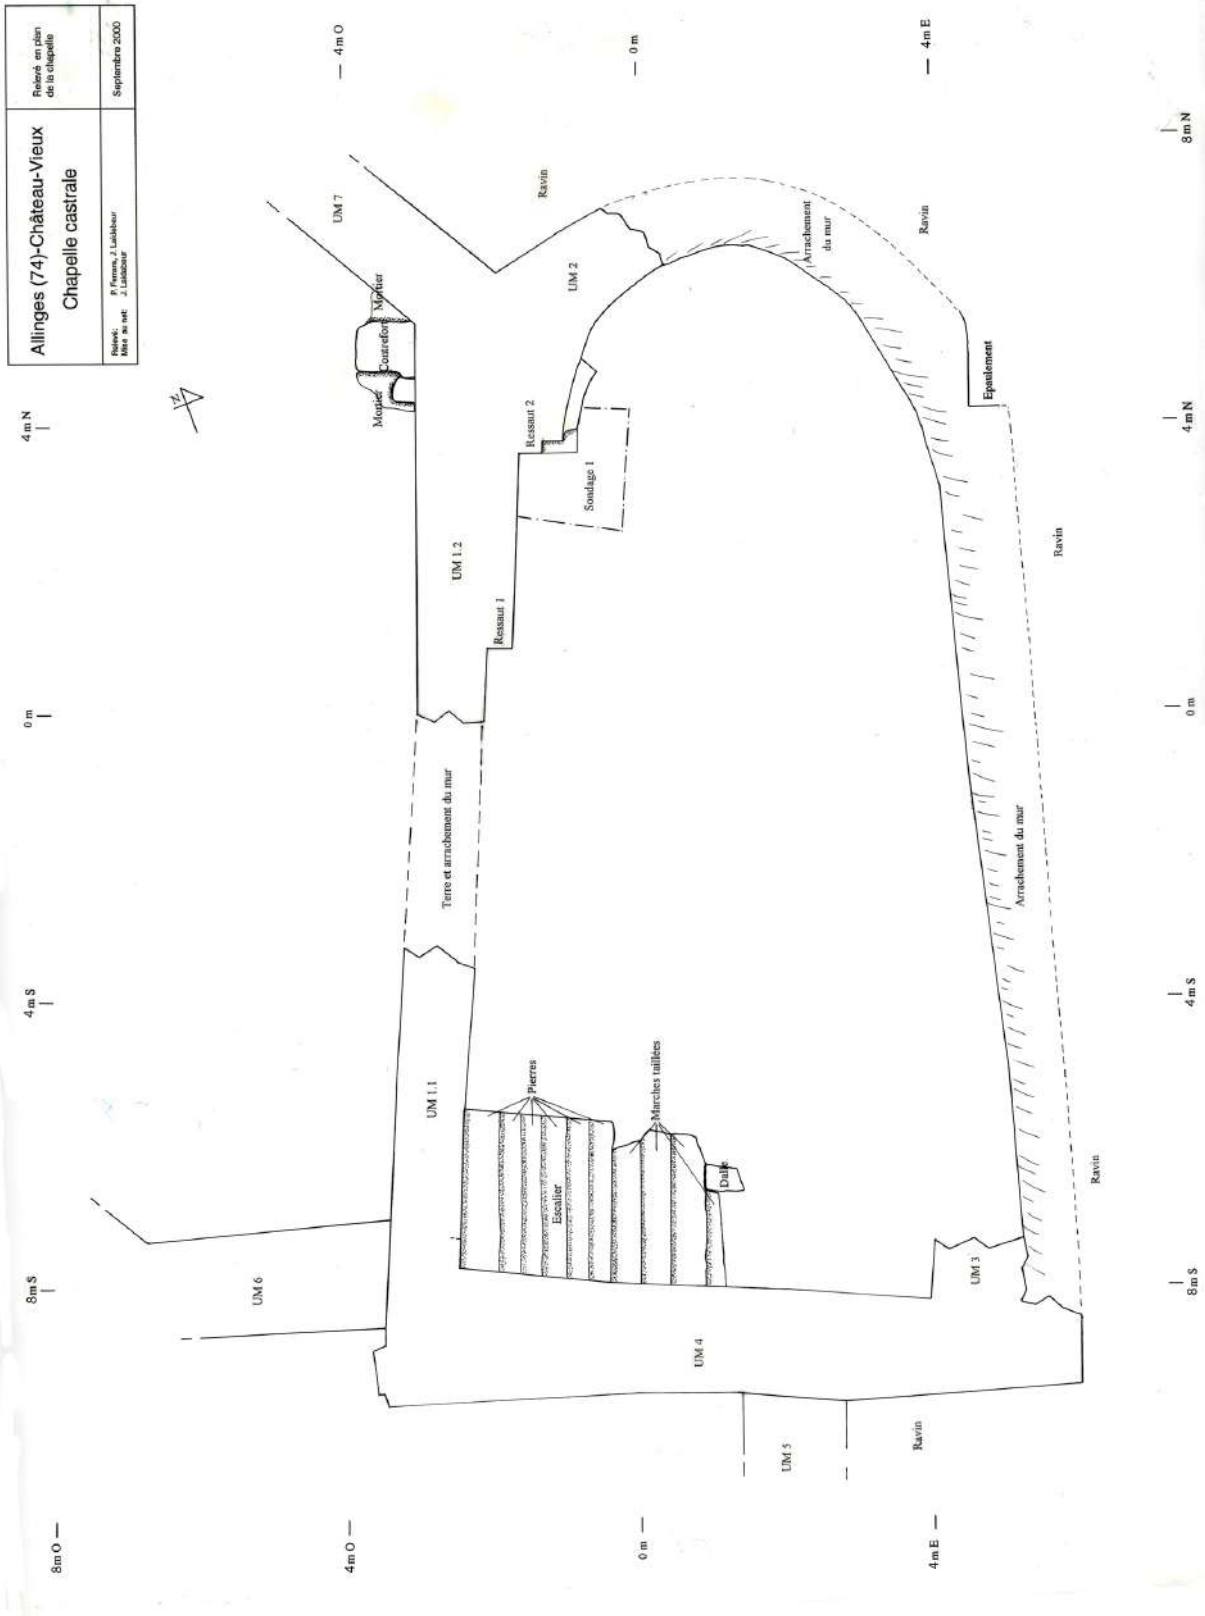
Plan de la chapelle de Château-Vieux d'Allinges. DAO : J. Laidebeur.
